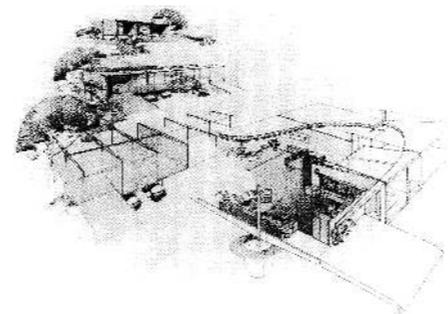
Perspectiva de Richard Neutra. Muestra la configuración estructural de portigo con vigas en voladizo, equilibradas con tensores perimetrales.
